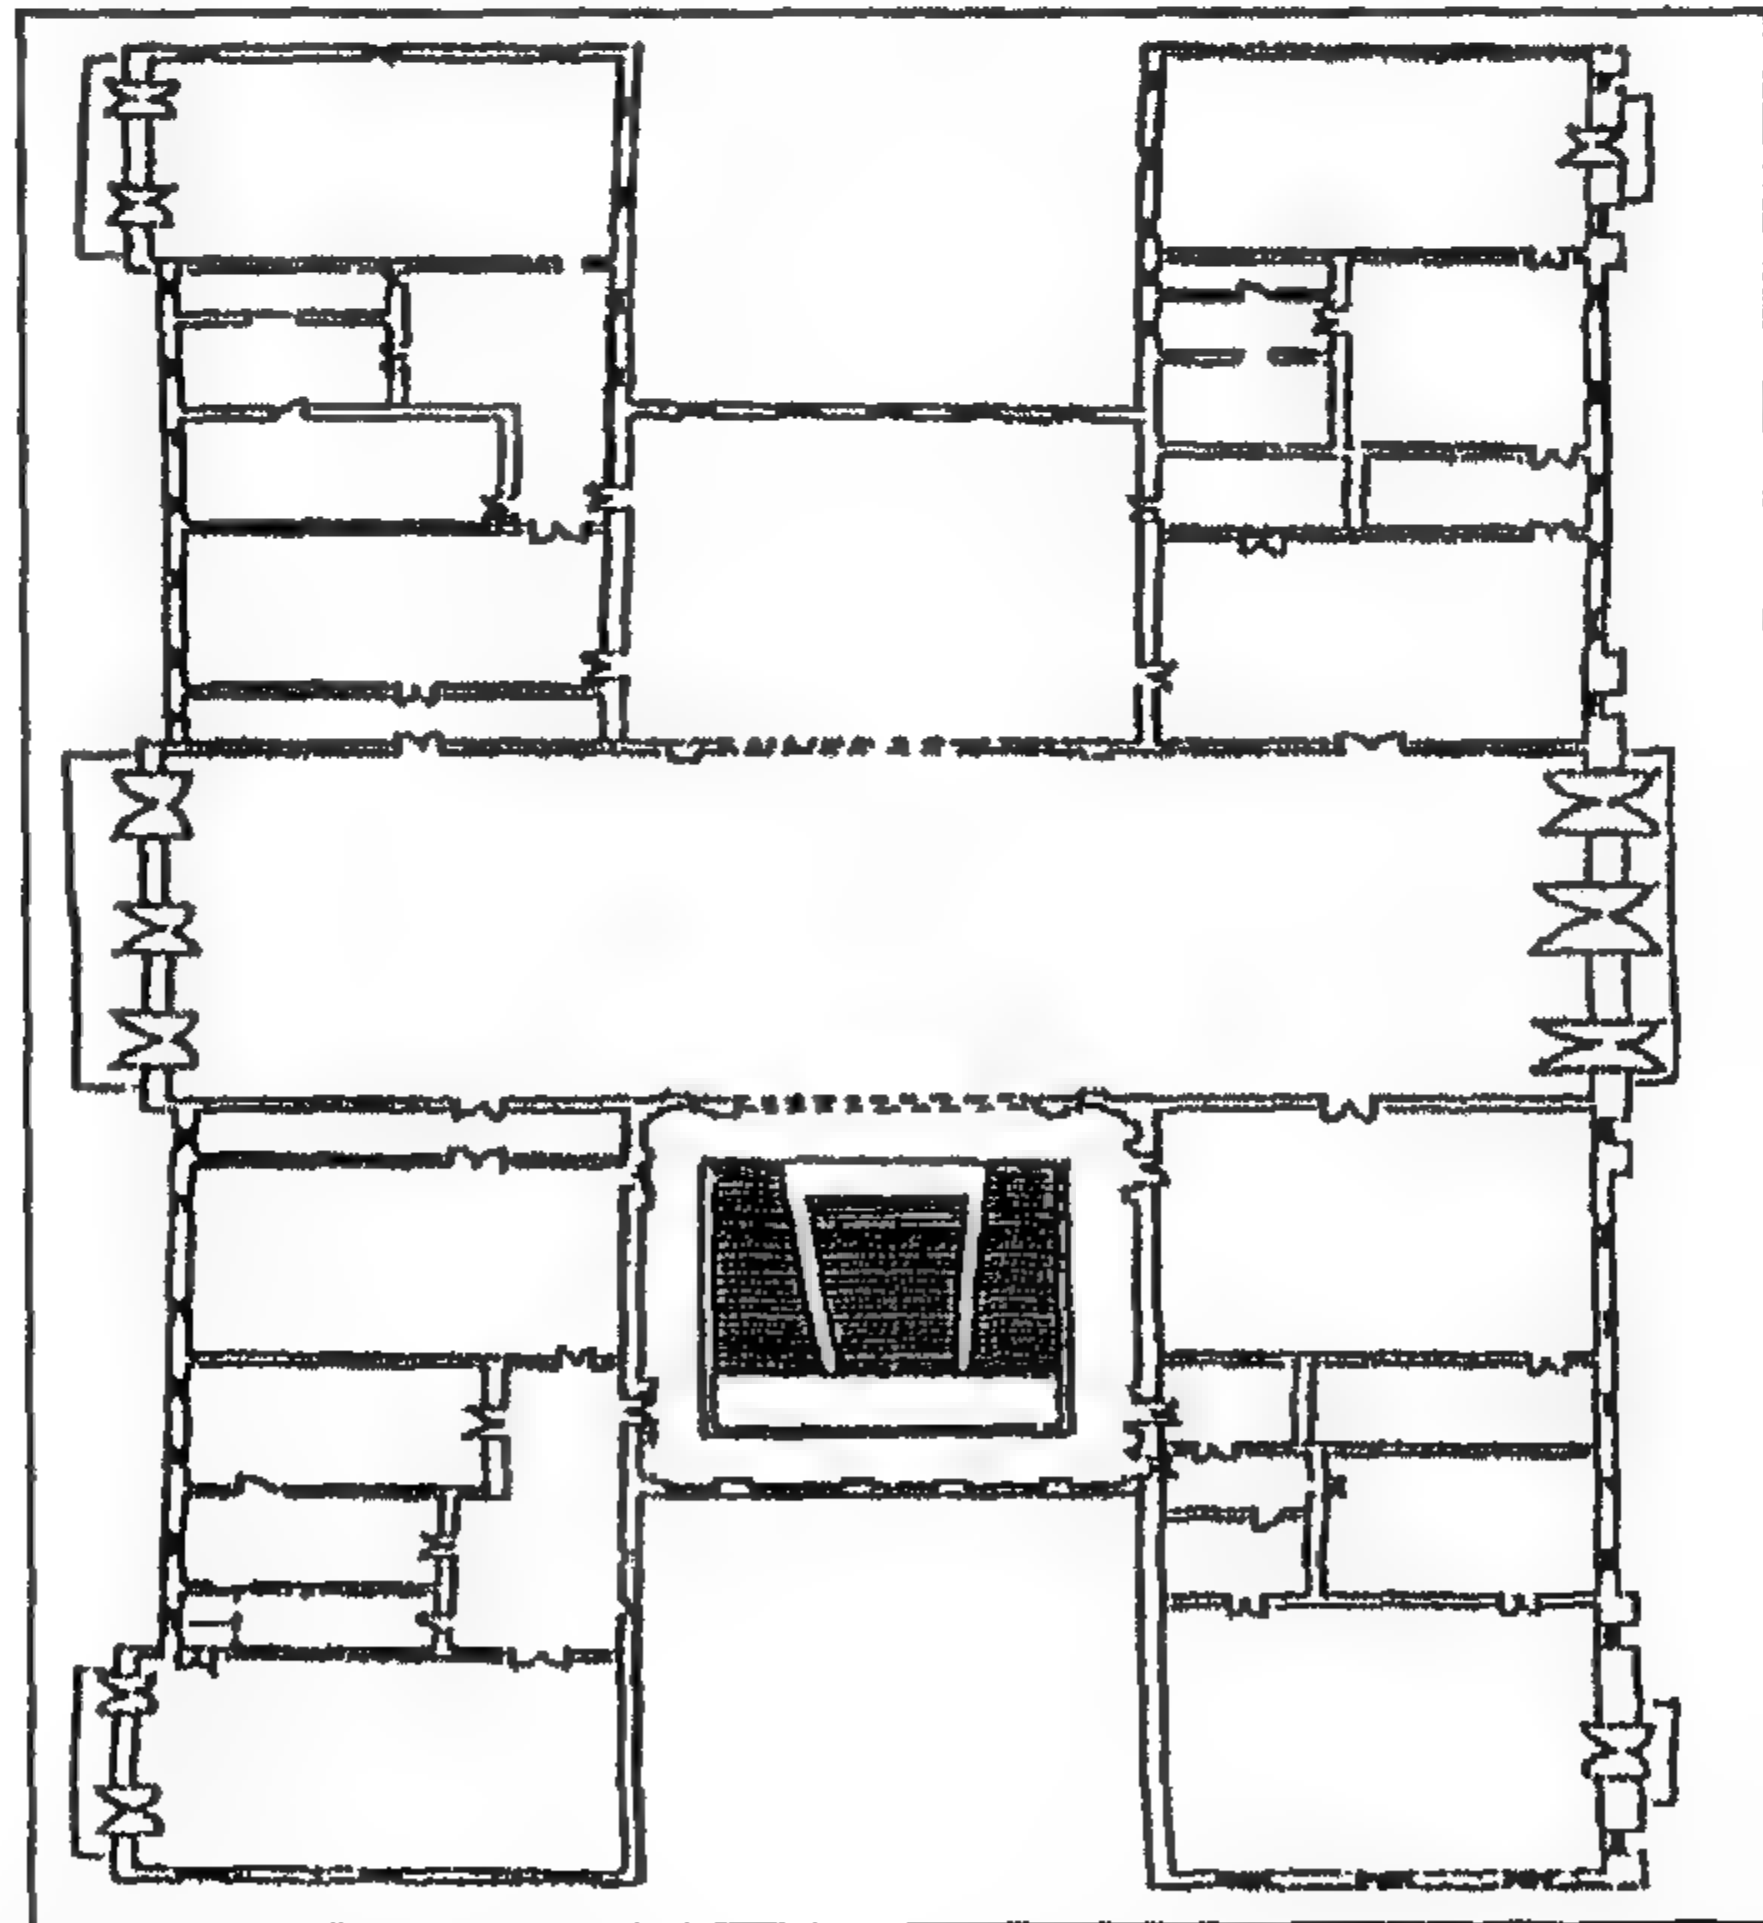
مسقط أفقى الطابق الأول لقصر إسماعيل صديق المفتش عن
